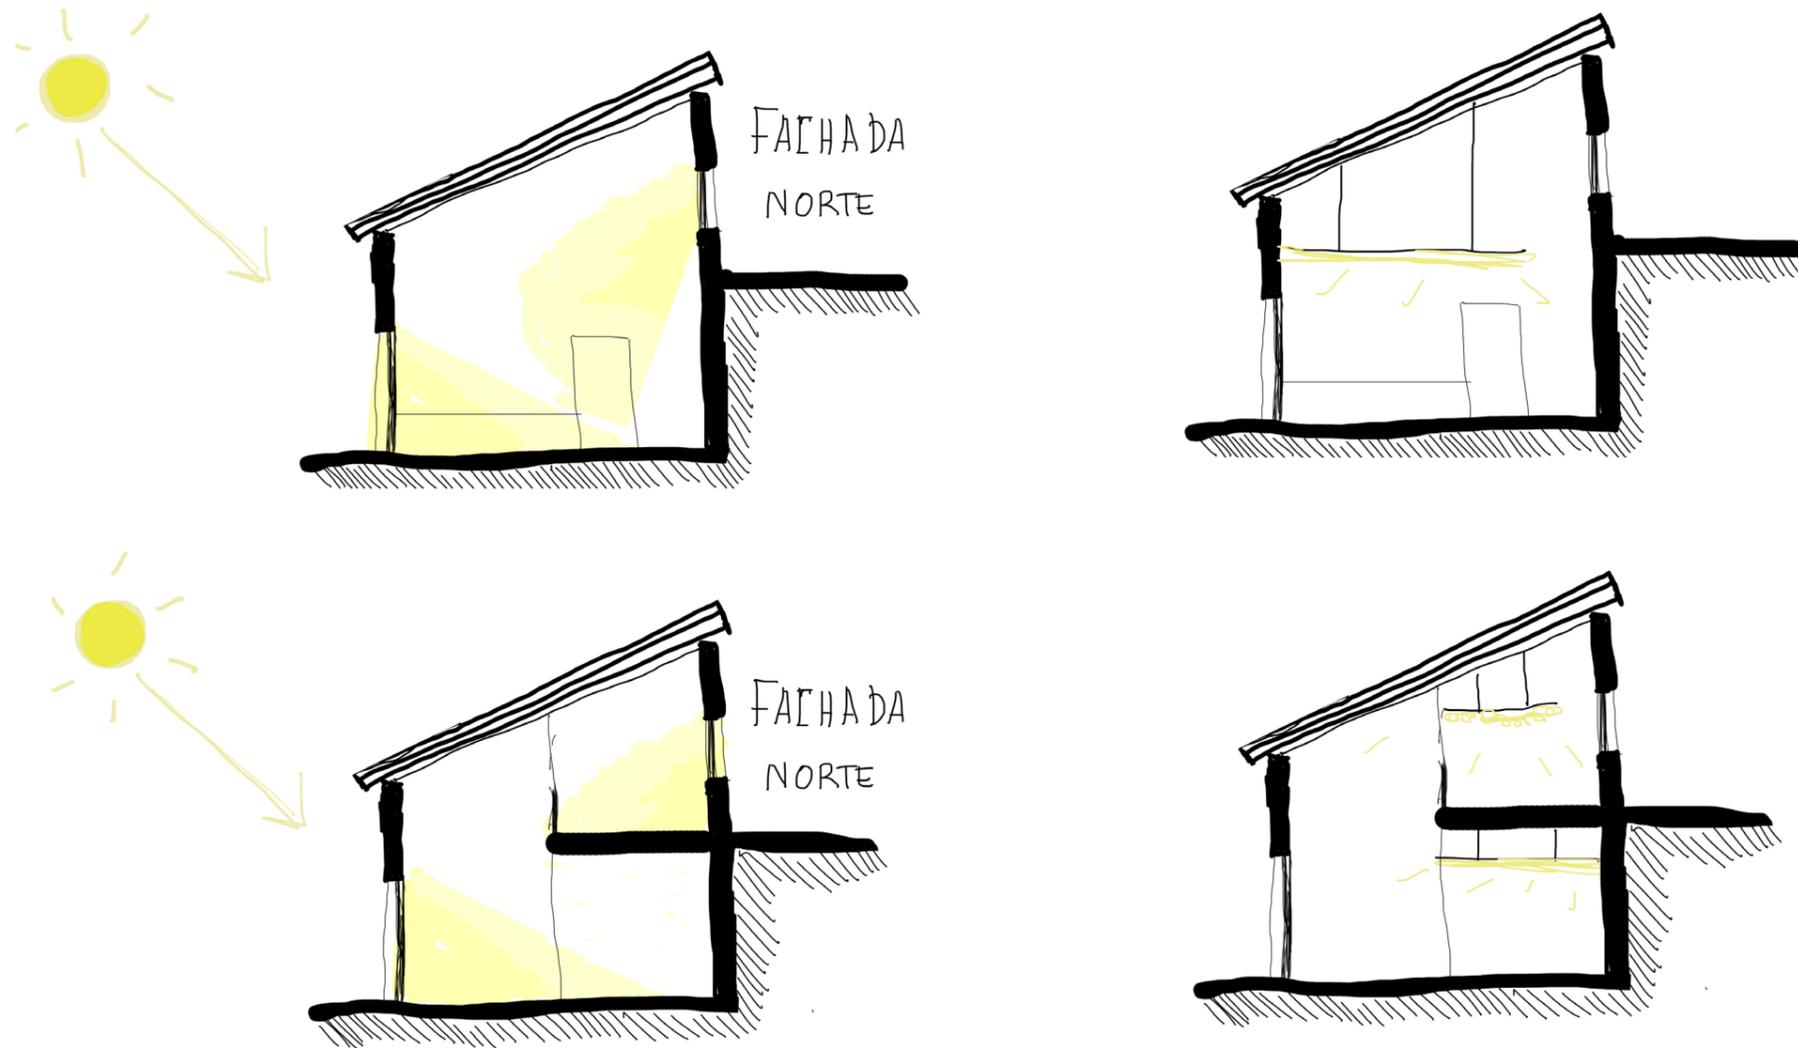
Esquemas de iluminación. Fuente: Elaboración propia
